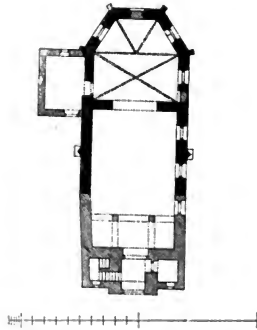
Magdalena. Grundriss der Kirche.
